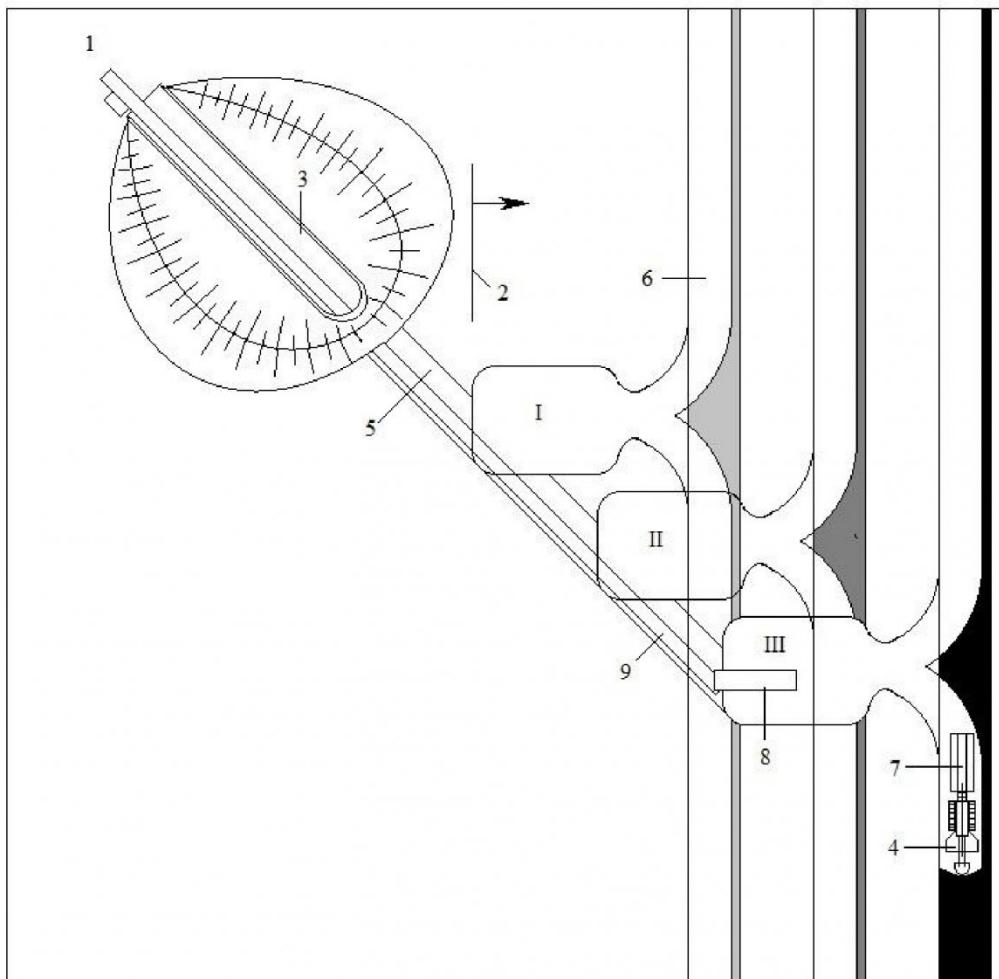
Схема вскрытия, подготовки и отработки угольного пласта (разрез вкрест простириания):
